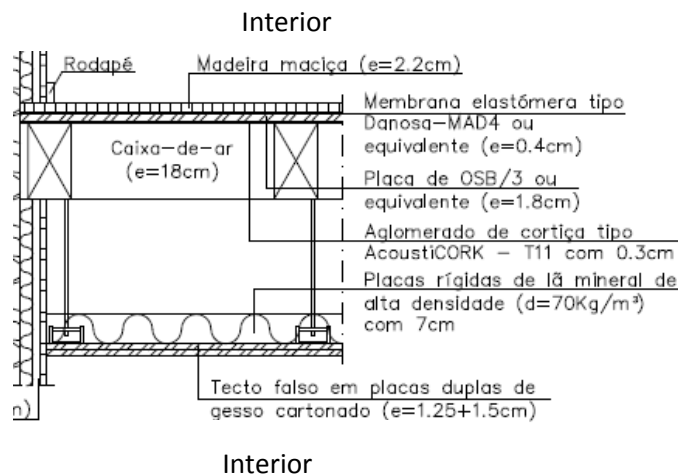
Pormenor construtivo do pavimento intermédio [19]
